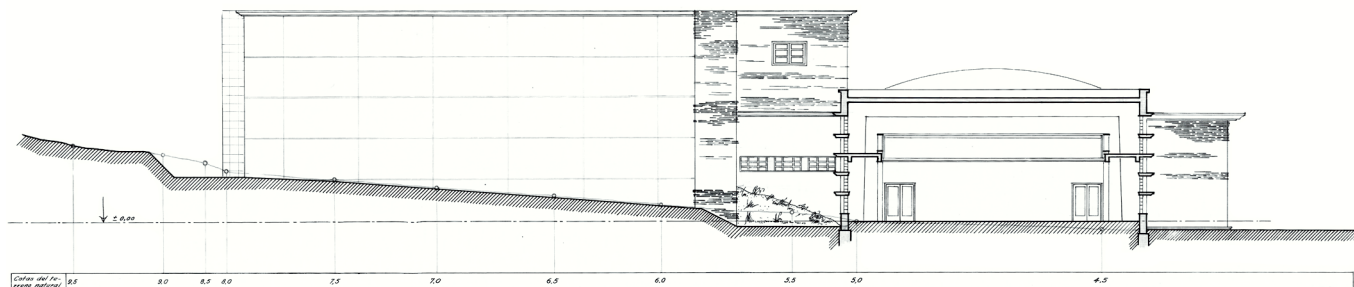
Corte B-B y Fachada / Desde la derecha, se aprecia, a detalle simple, los elementos que componen el pórtico de conexión; continuando, la conformación de la fachada posterior del bloque administrativo, un pasillo abierto que permite la relación con el exterior, se reutiliza el mismo pasamano colocado en la biblioteca; el auditorio seccionado, se aprecia el sistema portante que abarcaría grandes luces, en la parte inferior del auditorio, se ubica el corredor que conecta la zona de vestuarios con el escenario; por último, la biblioteca, relatando su fachada posterior y los elementos utilizados iguales al de sus otras fachadas.
